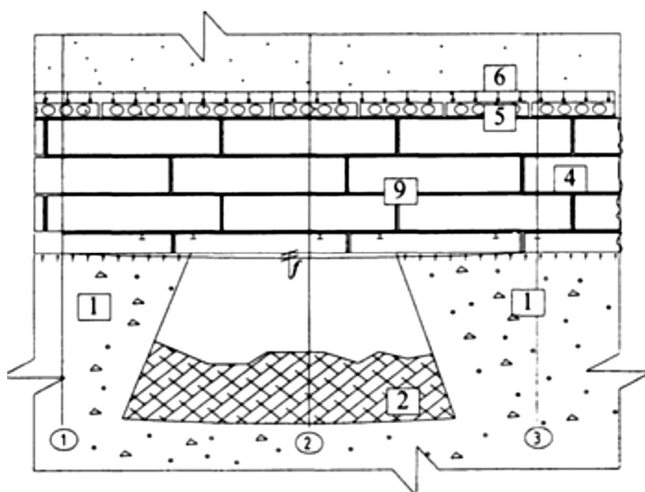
Схема сборного ленточного армированного фундамента над карстовым провалом:
